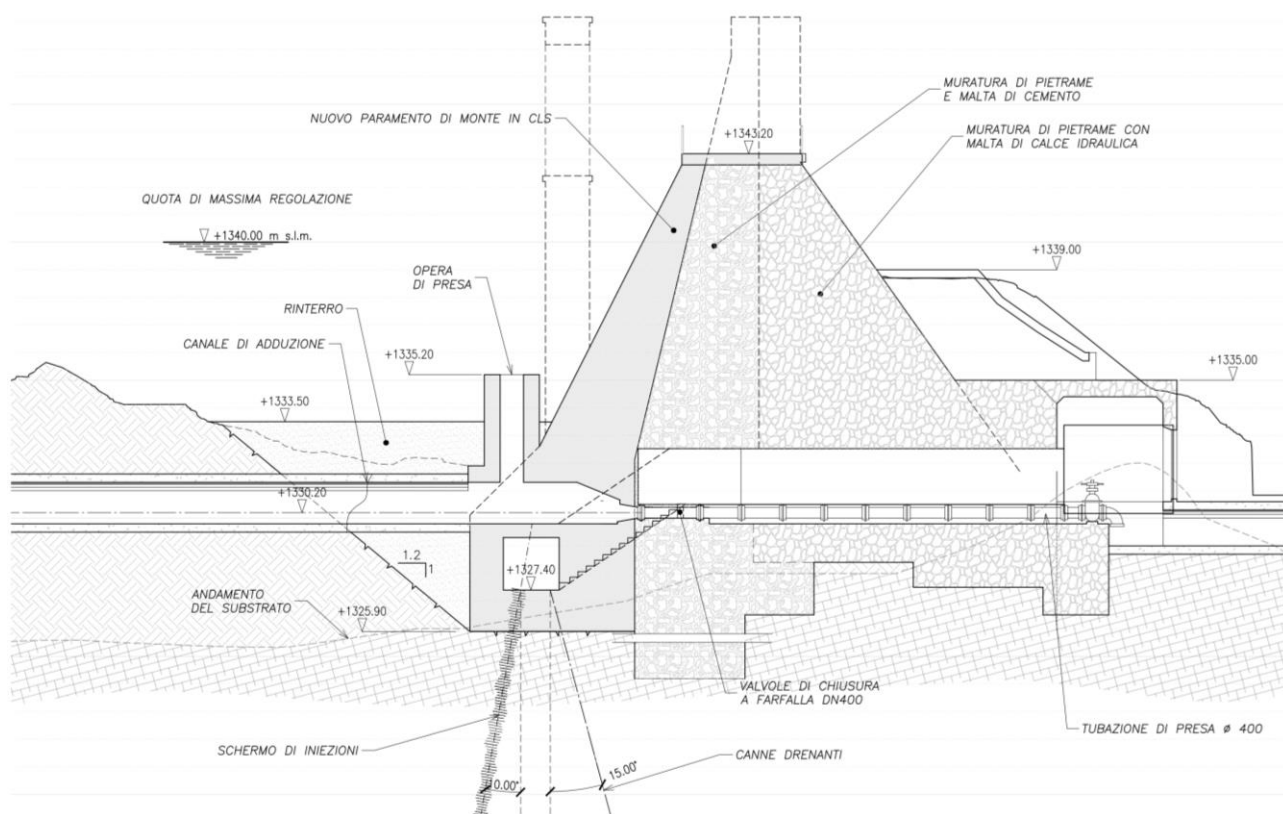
Sezione trasversale dello scarico di fondo e opera di presa
